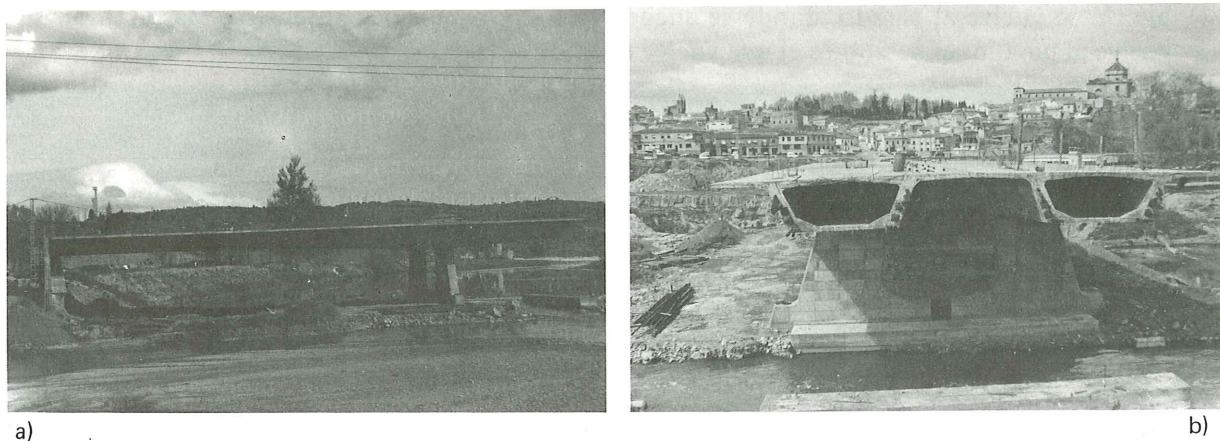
a) Primera fase de construcción terminada. b) Sección transversal.
